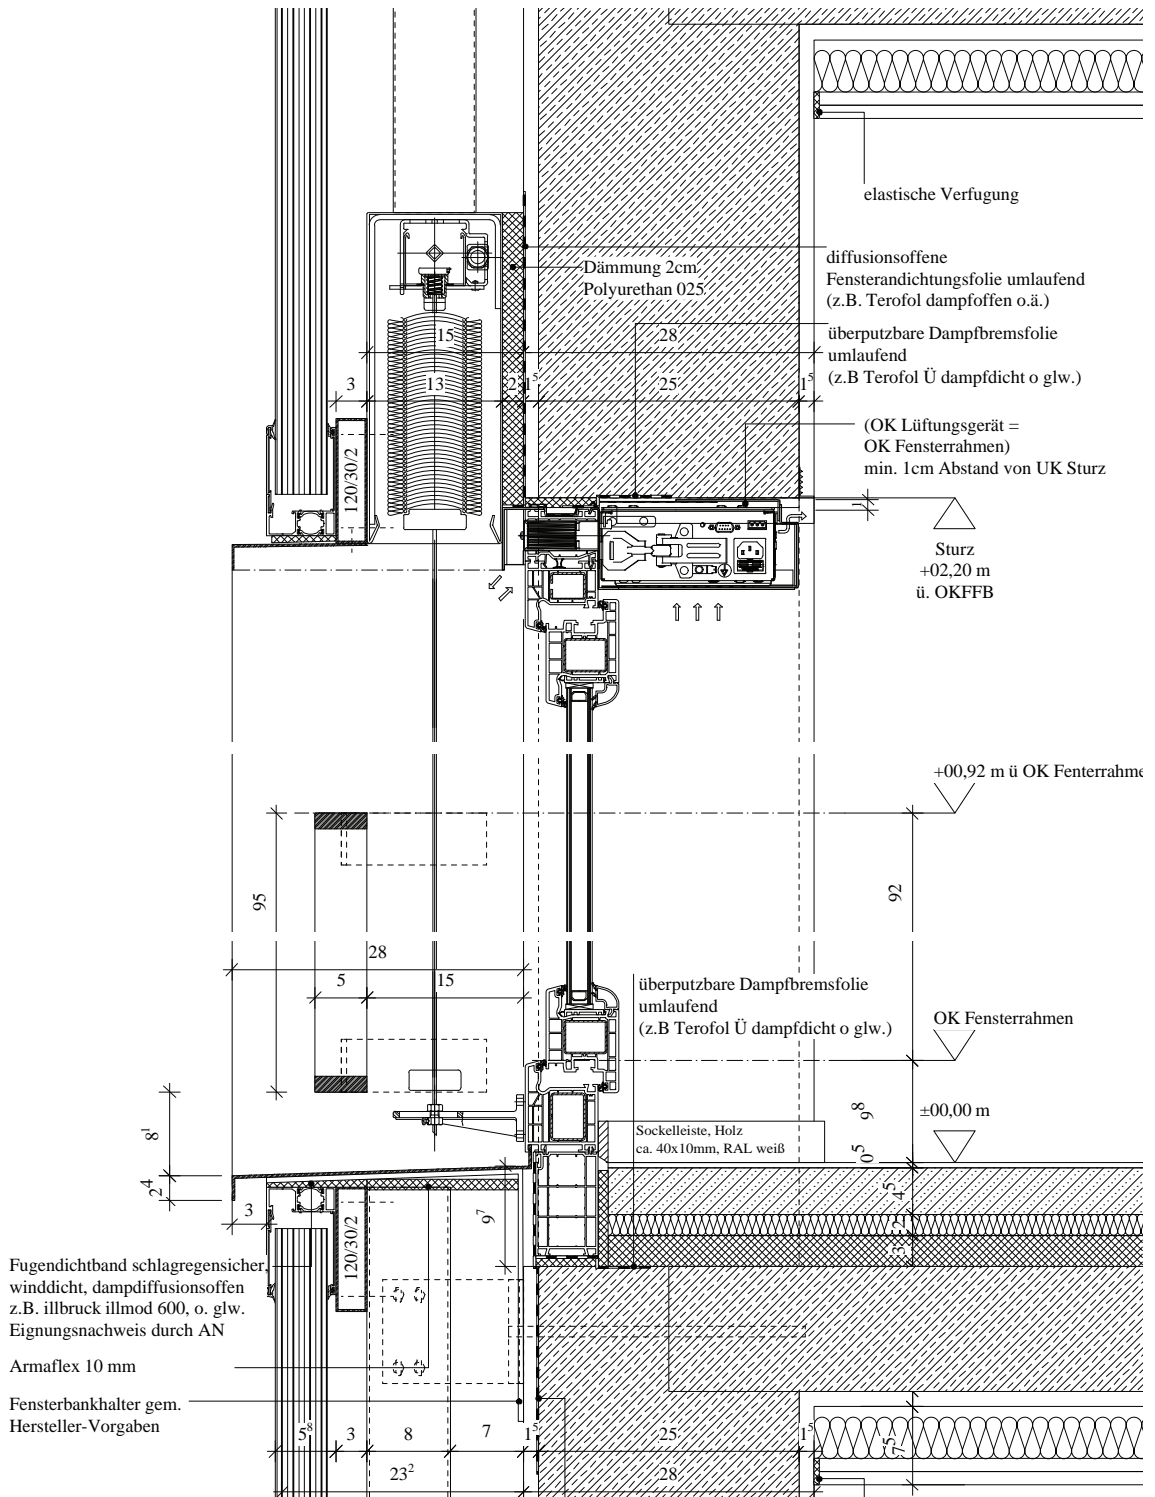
Fensterdetail Vertikalschnitt - Befestigung Zargen und Geländer über die Decken aus Stahlbeton
